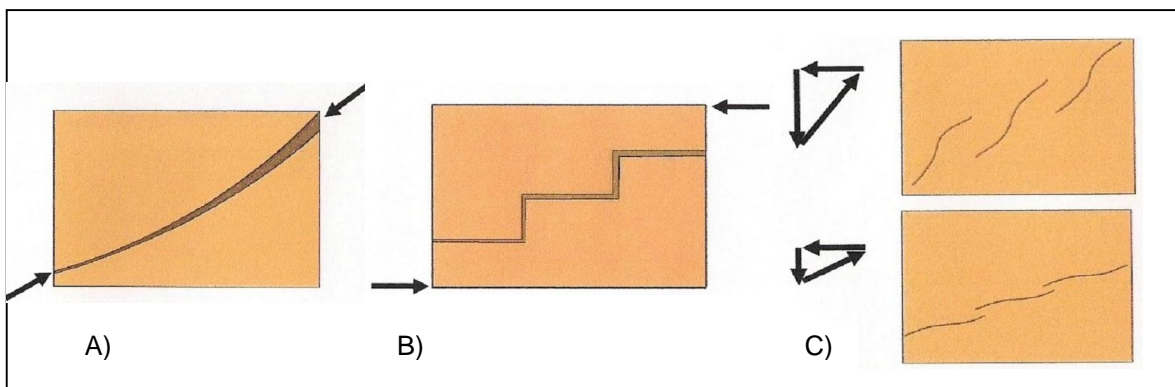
Manifestações típicas de fissuras. A) Formação de fissura diagonal. B) Formação de fissura escalonada. C) Combinação de fissuras
